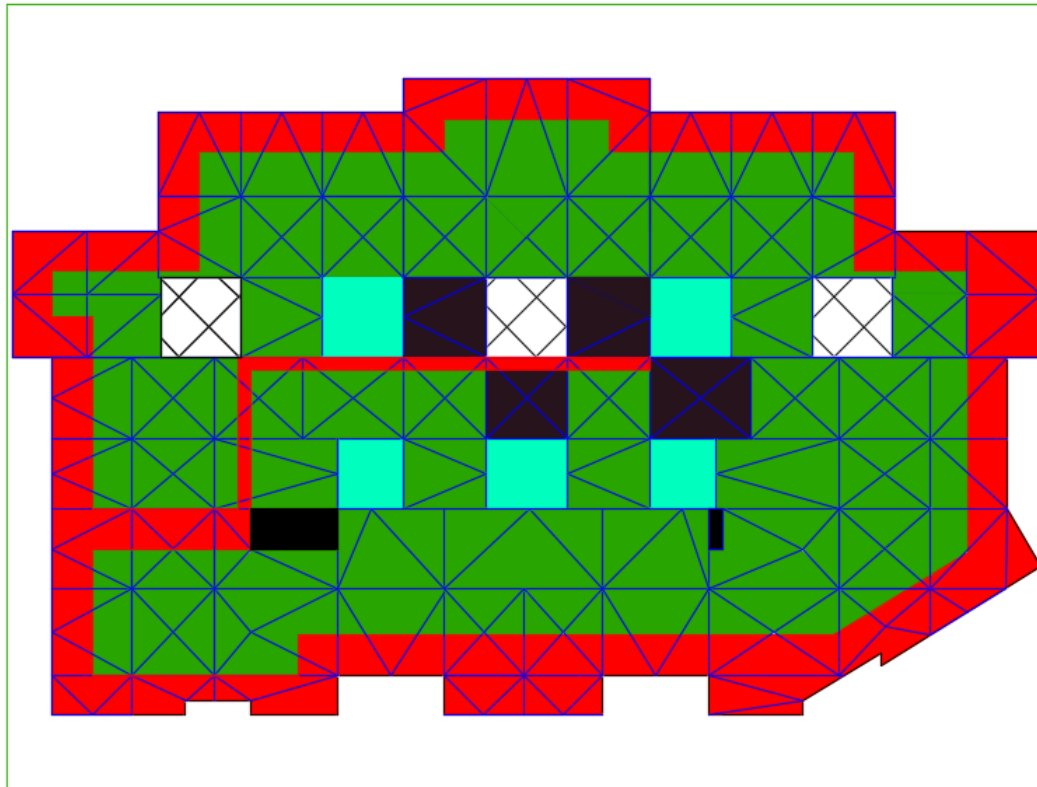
Plano tejado. Fuente: Elaboración propia
